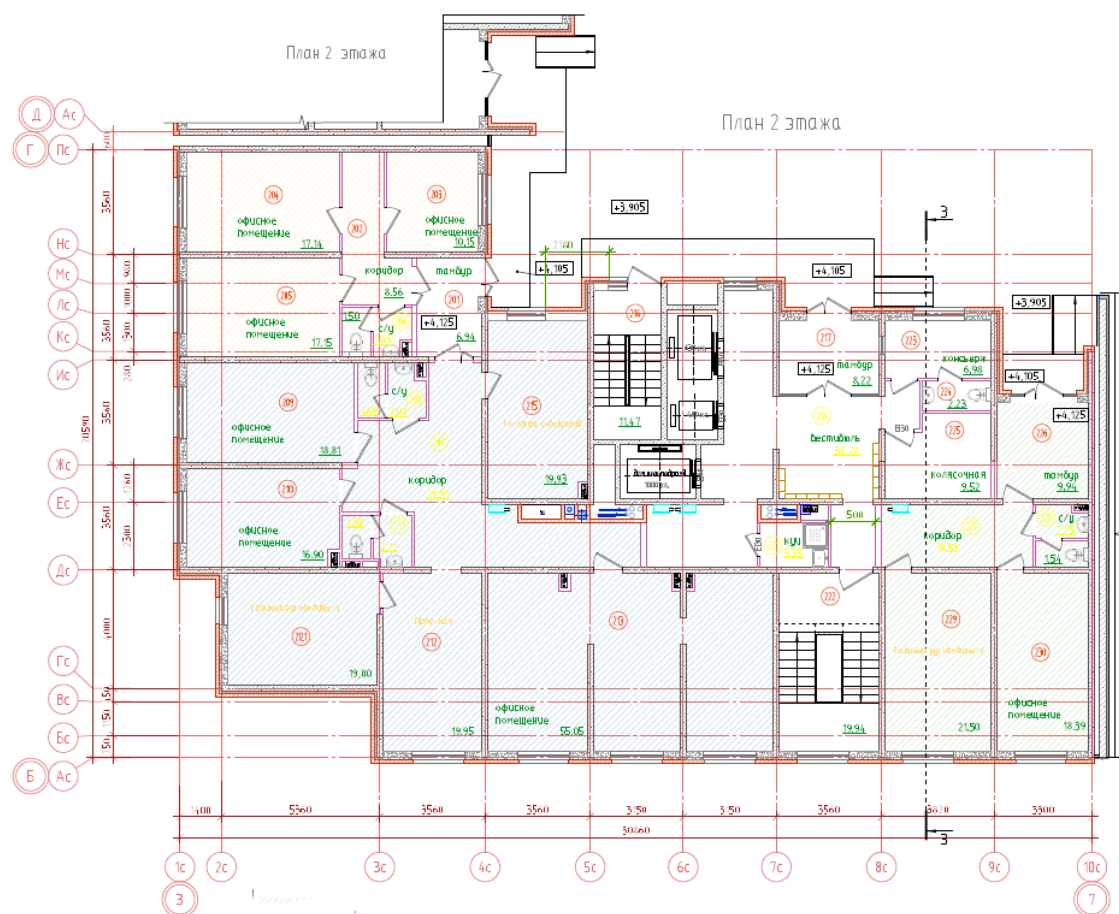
План 2 этажа БС-1 ЖК URAL
